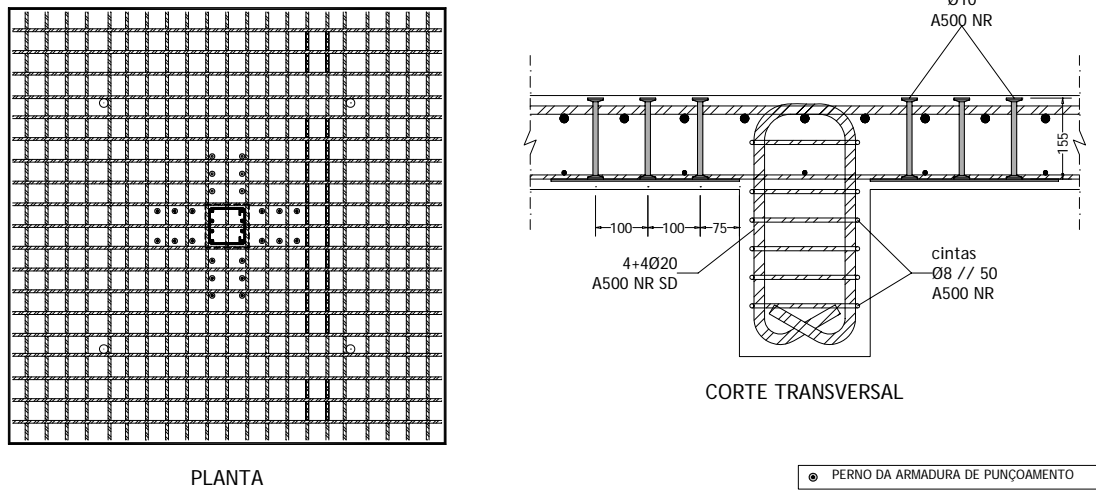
Pormenores das armaduras longitudinal (superior) e transversal. Dimensões em mm.
